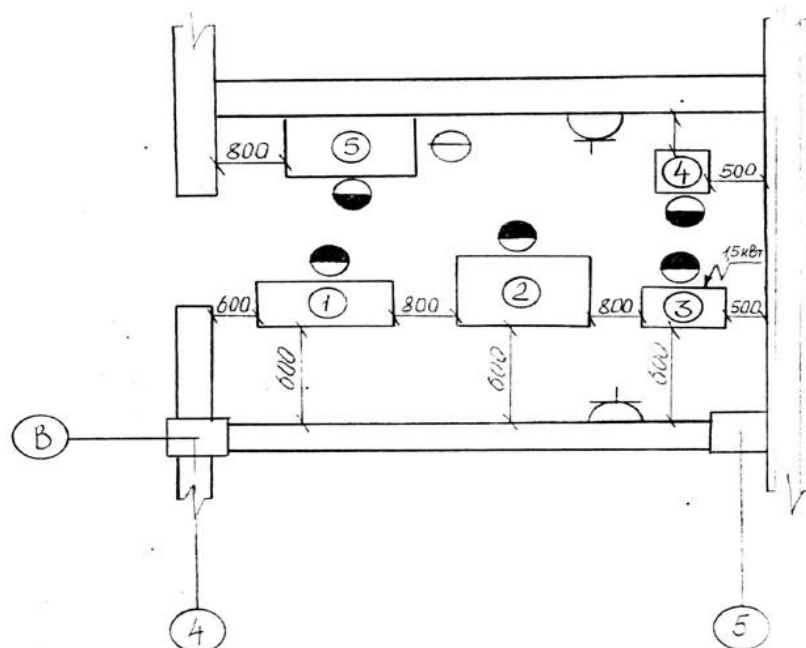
Планировка шиномонтажного участка: 1 – стенд монтажа и демонтажа шин; 2 – верстак для ремонта шин 5102; 3 – станок точильный 332-Б; 4 – электровулканизатор 6134; 5 – ванна для проверки камер Р-508.
